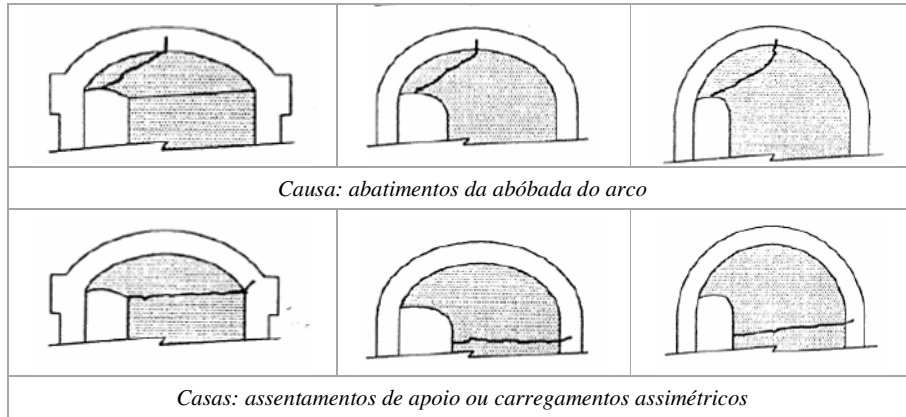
Tipos de fissuras transversais e possíveis causas (IQOA 1996)
